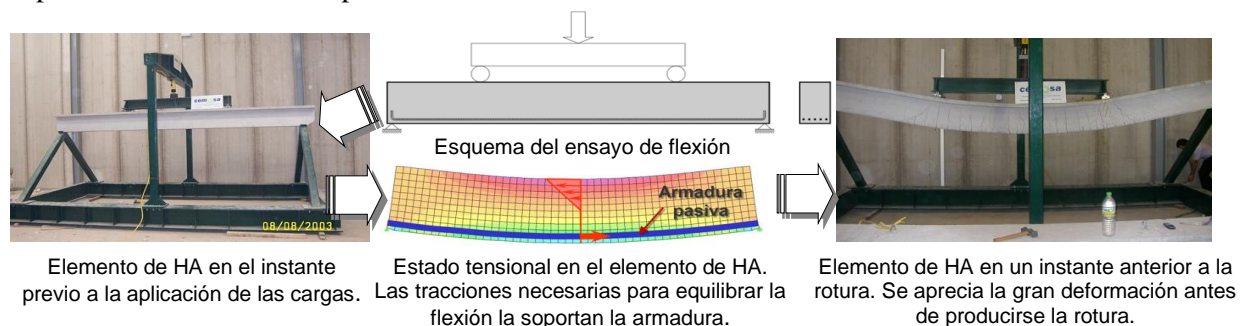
Ensayo de flexión de un elemento de hormigón armado.
